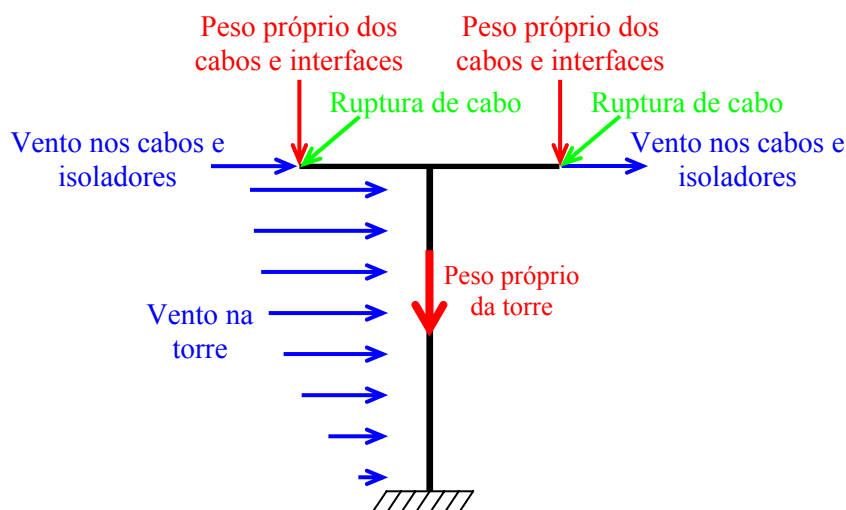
Carregamento típico em torres de LT do tipo tangente (suspensão).
